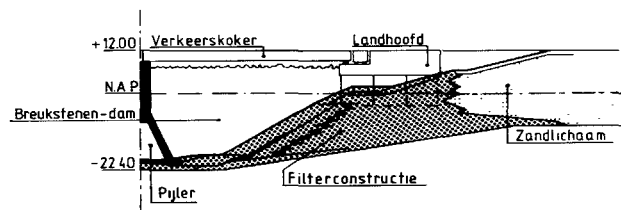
Aansluiting damaanzet op bestaande constructie (dwarsdoorsnede).
